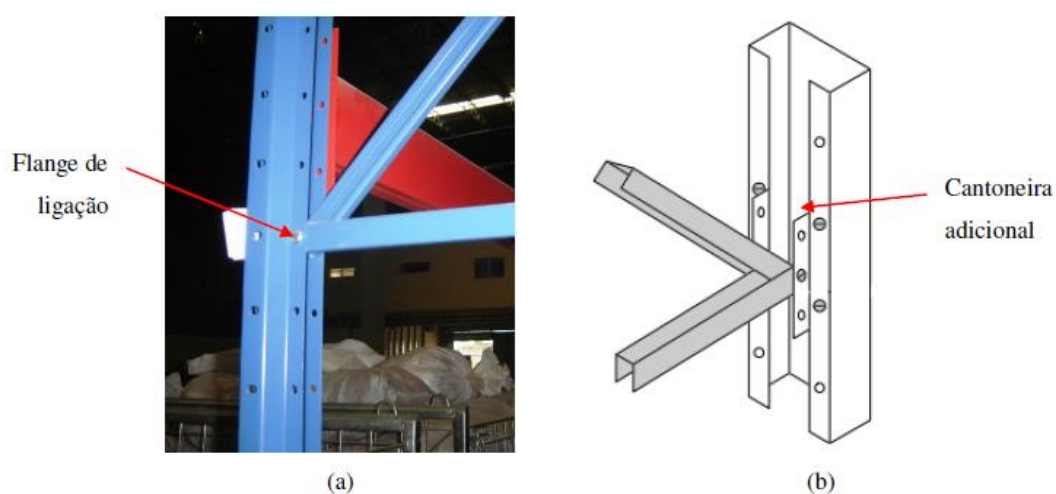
Ligação das travessas e diagonais nas colunas: (a) com flanges de ligação da seção tipo rack; (b) com cantoneiras adicionais na seção U enrijecido
